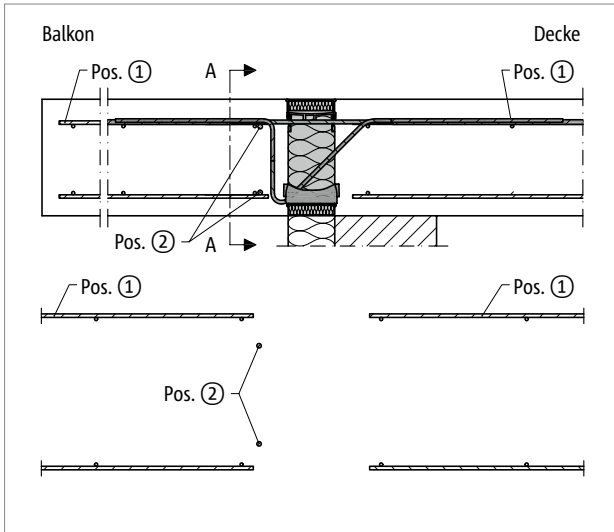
Schöck Isokorb® T Typ KL: Bauseitige Bewehrung bei direkter Lagerung
